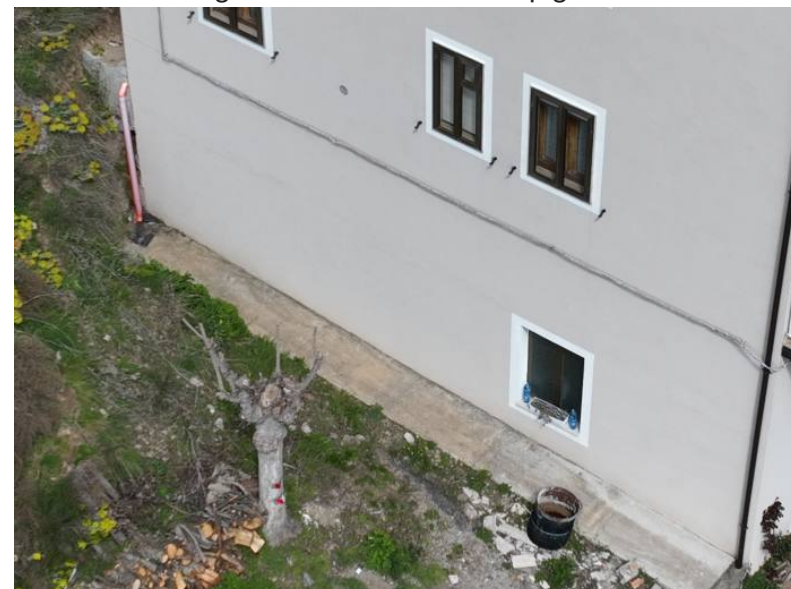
Vista della parete sud e del marciapiedi ad essa affiancato non ancora dotato di pavimentazione
